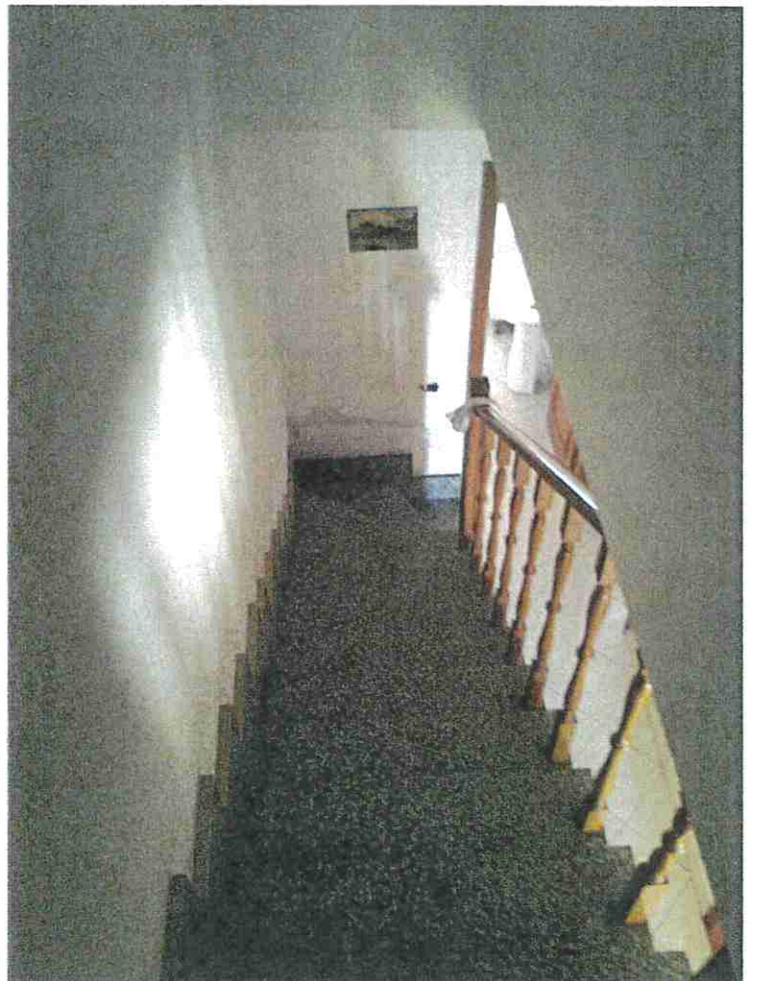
SCALA DI ACCESSO AL PIANO 1°
